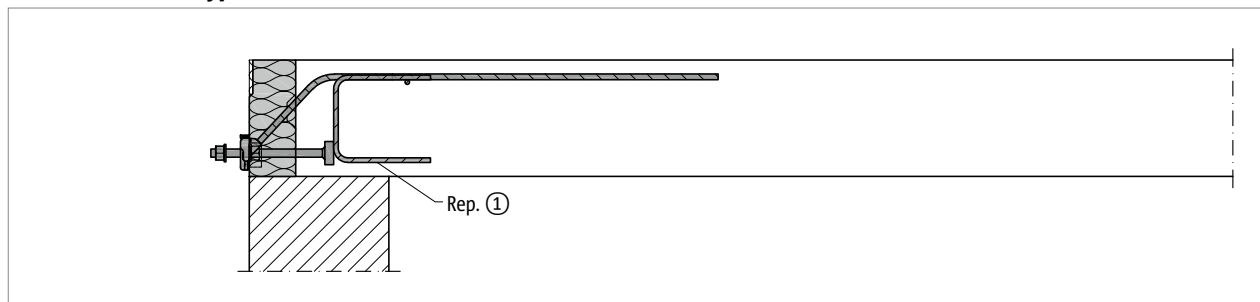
Schöck Isokorb® T type SQ : armatures à prévoir par le client, vue en coupe
